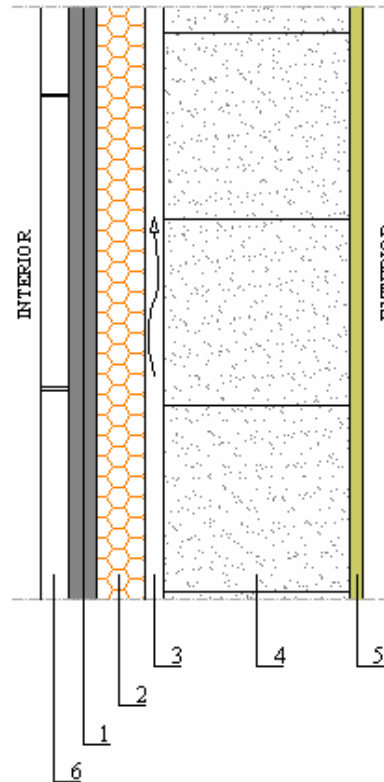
Composición de los muros exteriores con alicatado (Norte)
